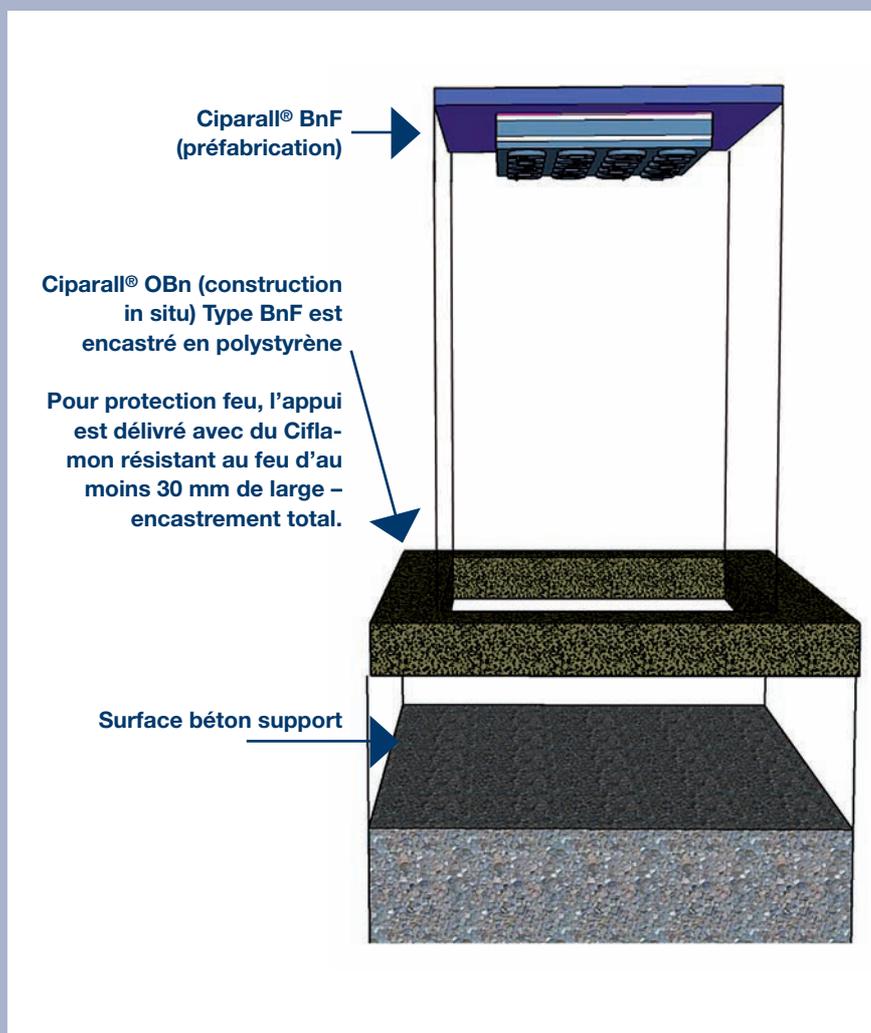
Principe d'installation CIPARALL® type BnF ou OBn sur un poteau
